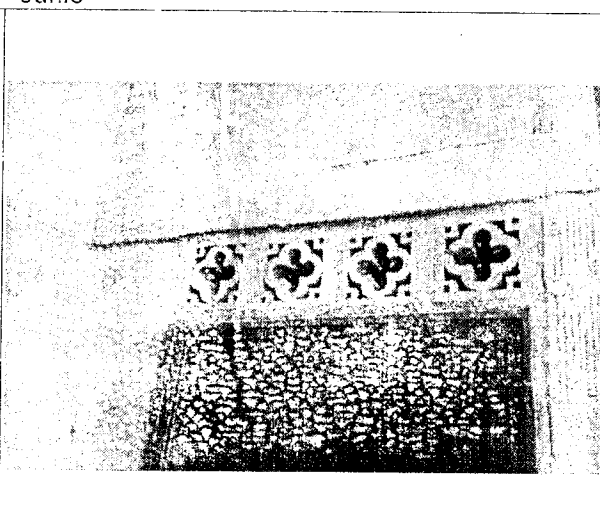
Manzana B casa 21. Las viviendas de esta manzana tienen instalados cuatro calados para ventilación sobre el dintel de la puerta de la fachada principal y posterior.
